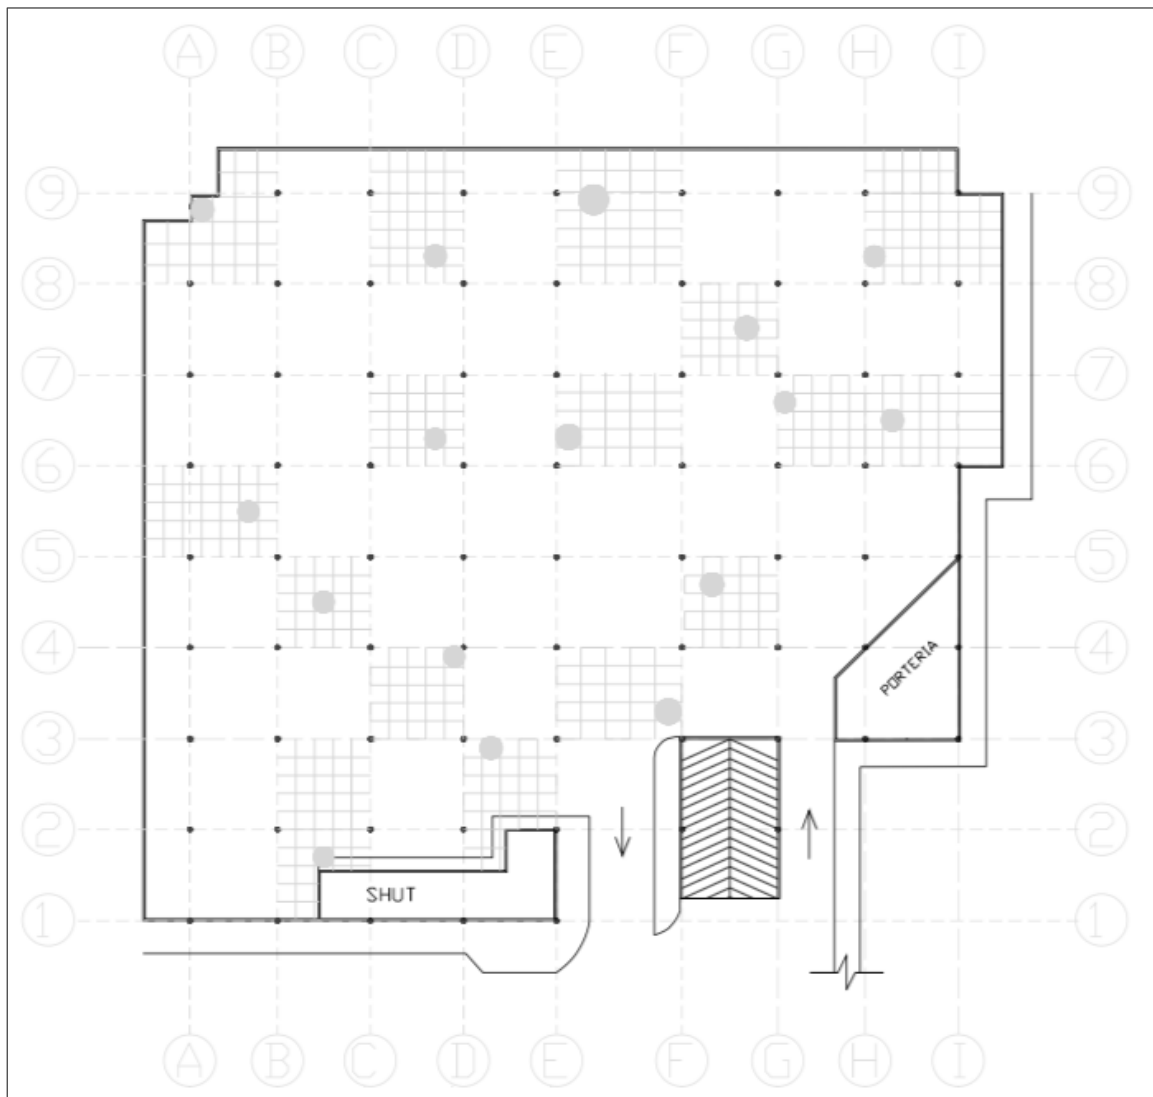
Plano de ubicación puntos a instalar fisurómetros. Fuente: Elaboración propia.
